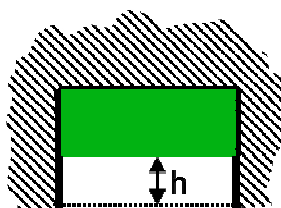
Schematische Darstellung der Schürzenvorrichtung im Tunnelquerschnitt
